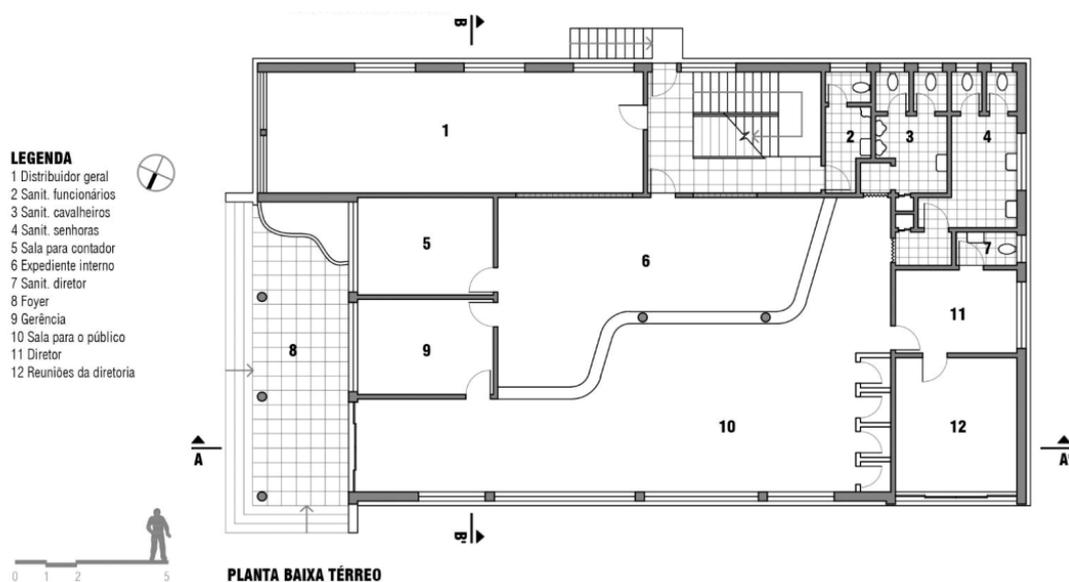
Planta Baixa do Térreo do Projeto da Cia Telefônica Municipal
